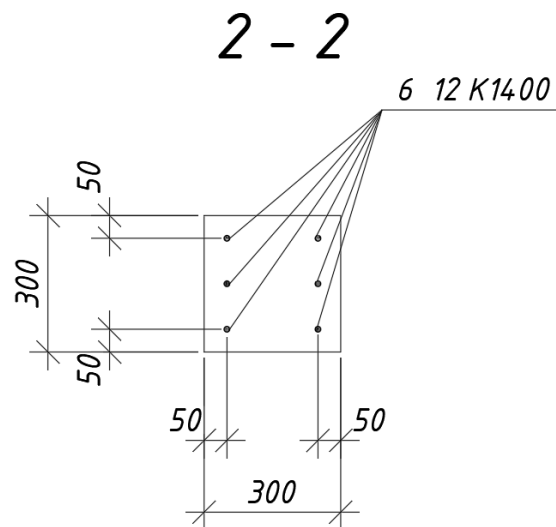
Схема розташування попередньо напруженої арматури в нижньому поясі ферми
